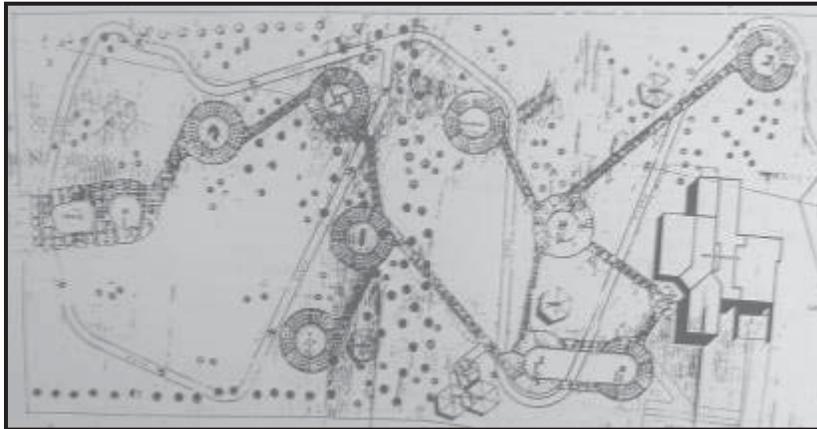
Plano arquitectónico de conjunto del parque Lázaro Cárdenas.
